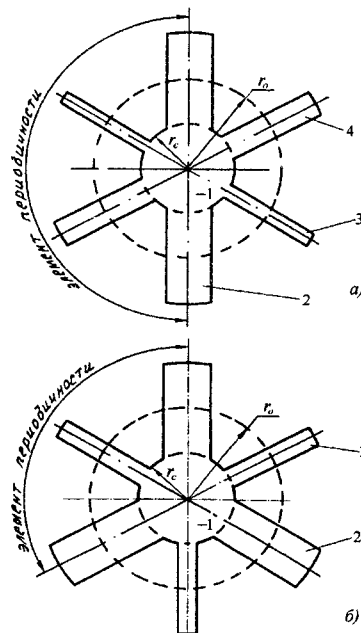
Схема конструкции полюса с шестью гребнями (вид в плане): а) с гребнями трех типоразмеров; б) с гребнями двух типоразмеров
